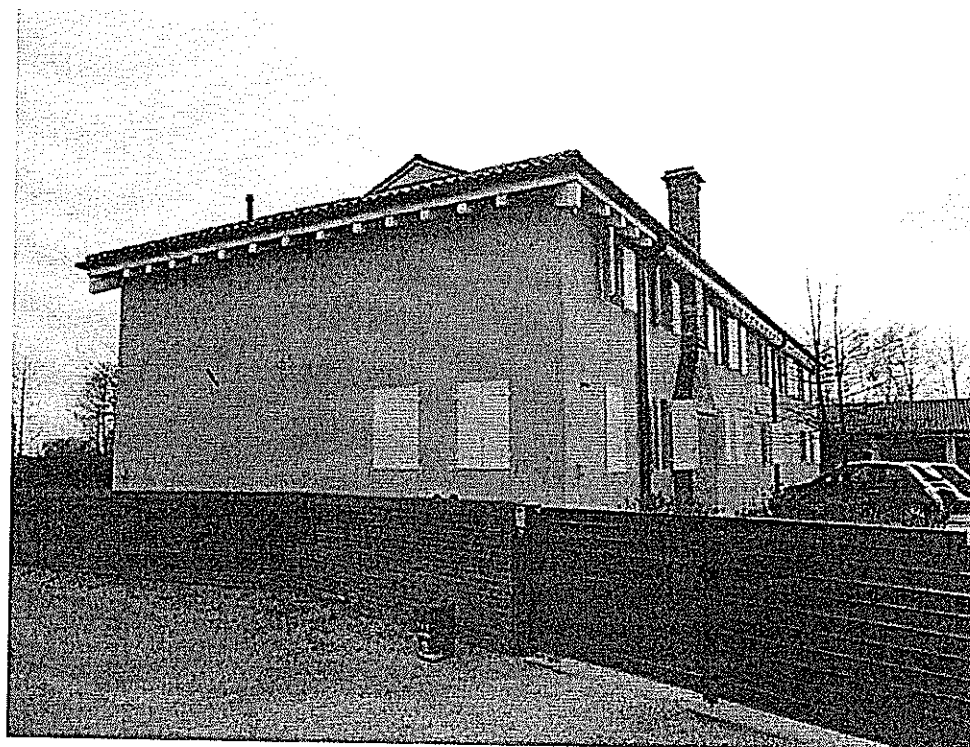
LOTTO B1 - visione esterna fabbricato - facciata laterale e posteriore
